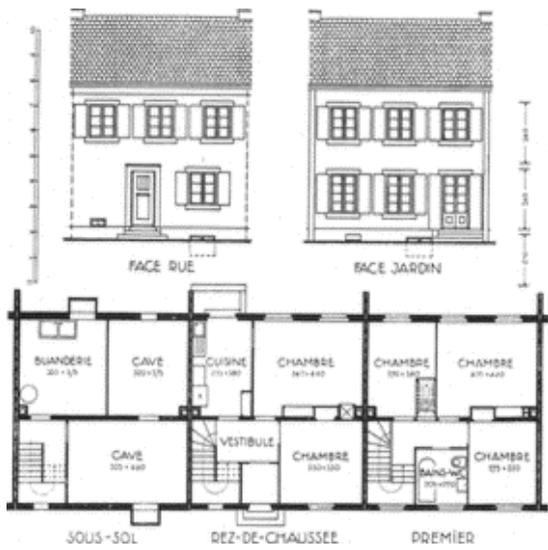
Façade et plan d'un second logement de la Cité-Jardin
